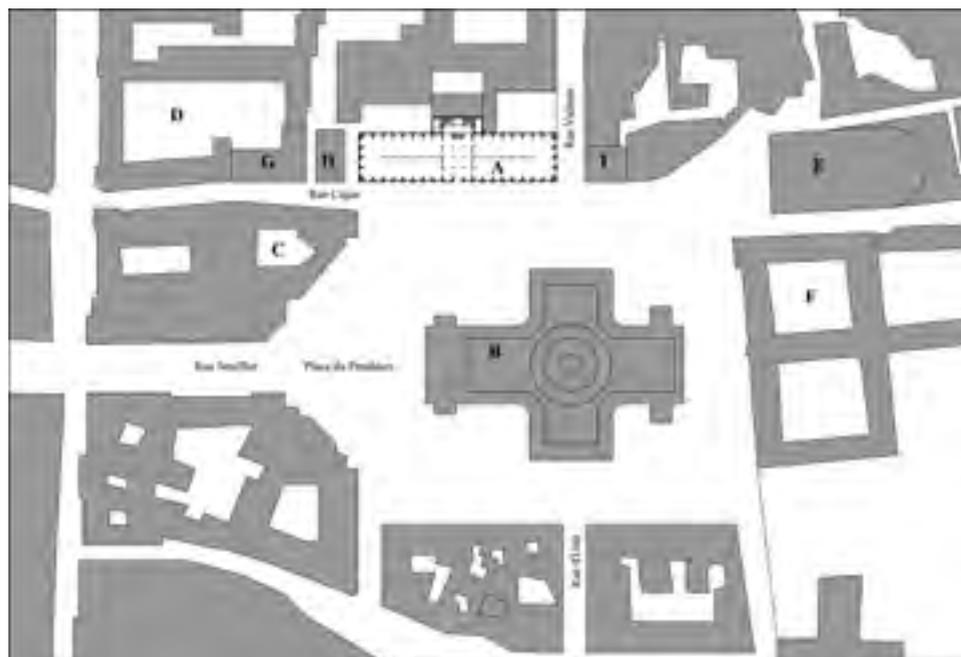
Planimetria generale di Place du Panthéon, con inserita la pianta del piano terra della biblioteca Sainte-Geneviève.
